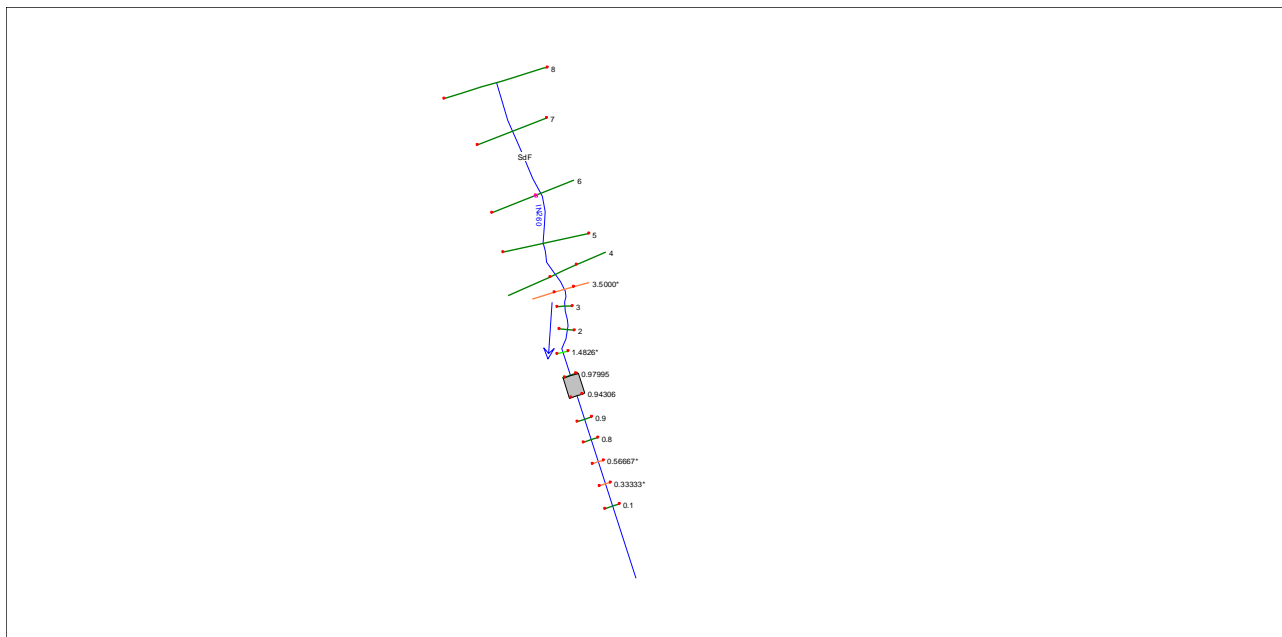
Planimetria modello 1D – stato di progetto interferenza IN260
